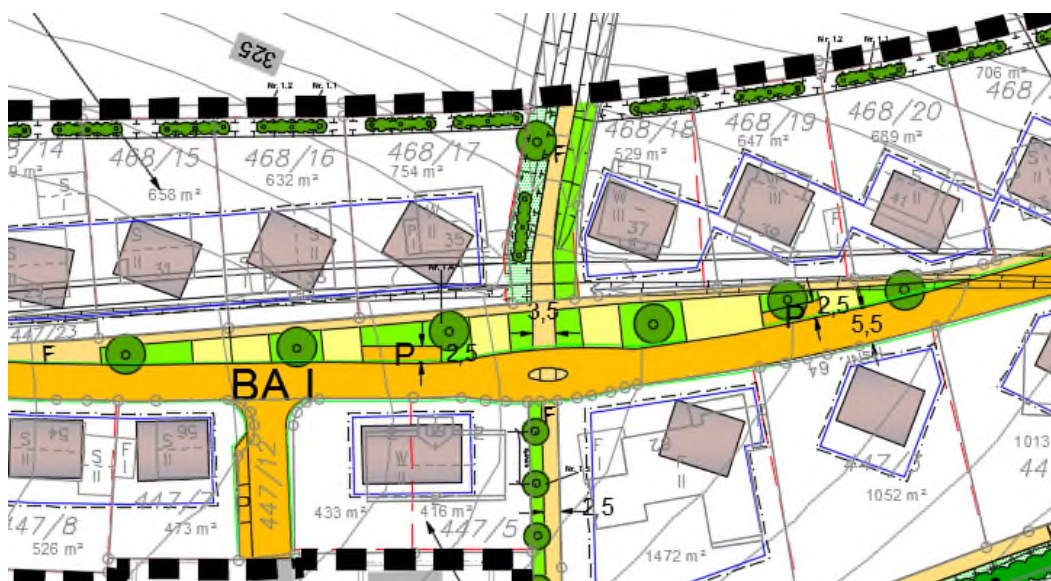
Geplante Änderung mit Festsetzung der Grundstückszufahrten als öffentliche Flächen, Festsetzung öffentlicher Parkplätze und geänderter Begrünung (Flächen und Standorte von Bäumen), ohne Maßstab
